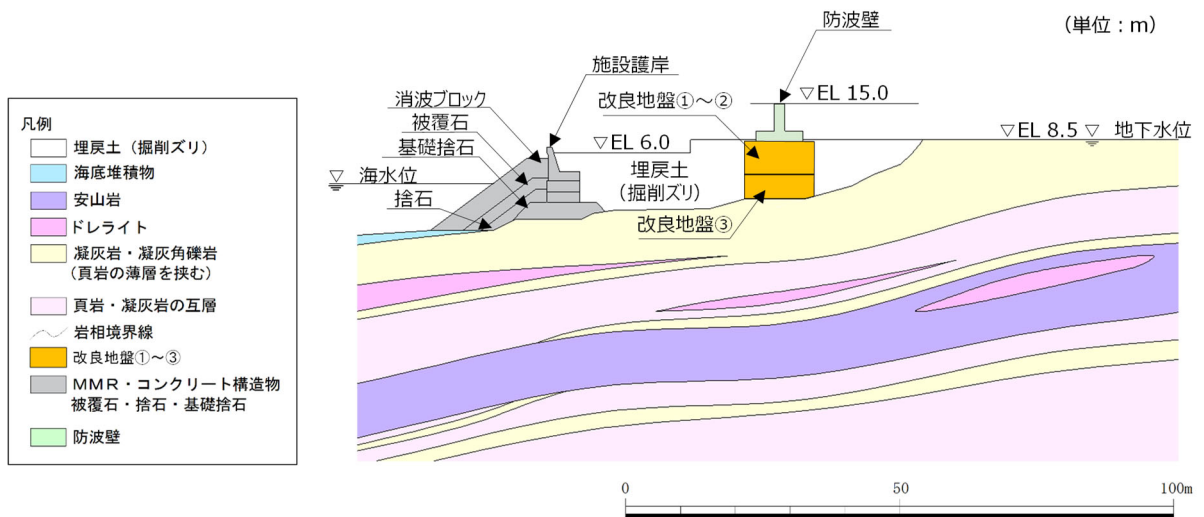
防波壁（逆 T 擁壁）の横断面図（①-①断面）
